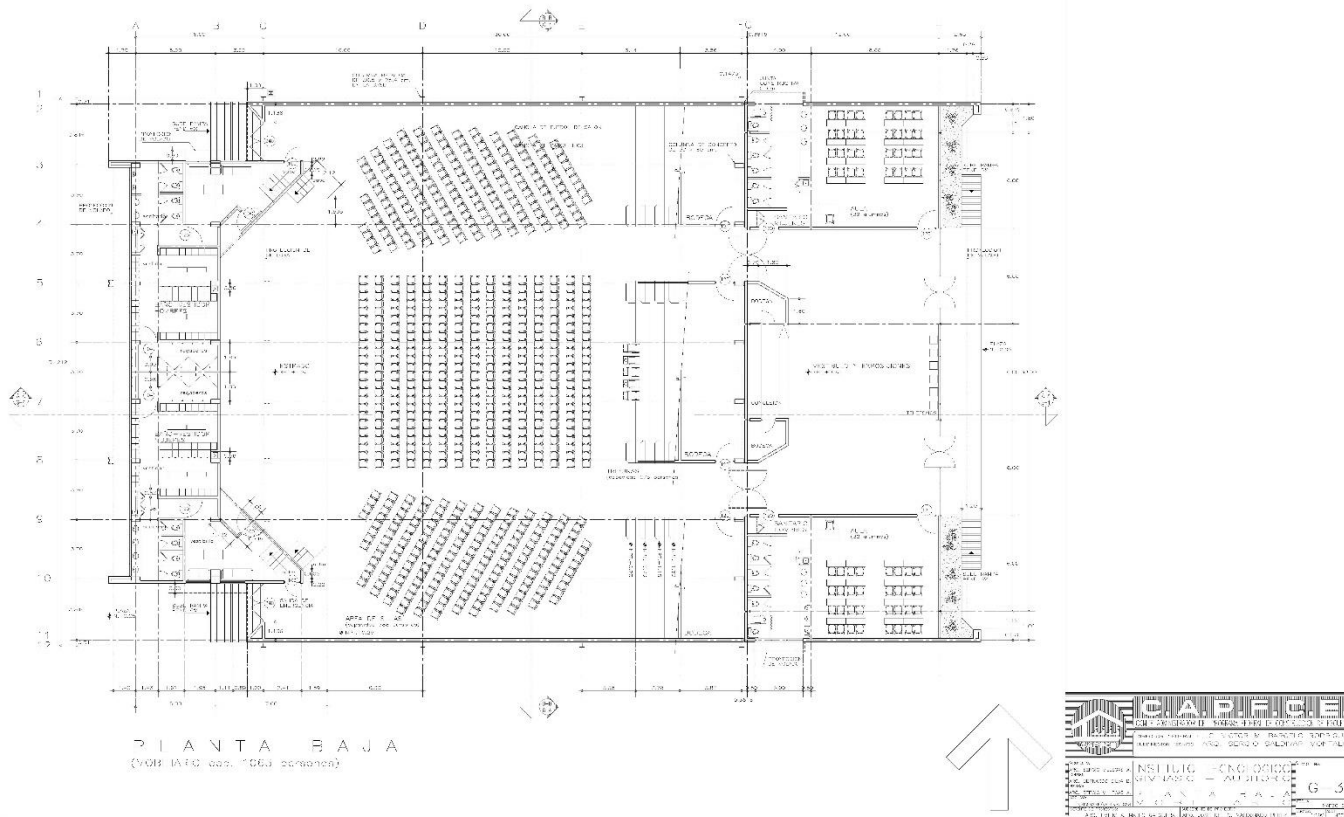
Plano arquitectónico del Centro Cultural Nogales
